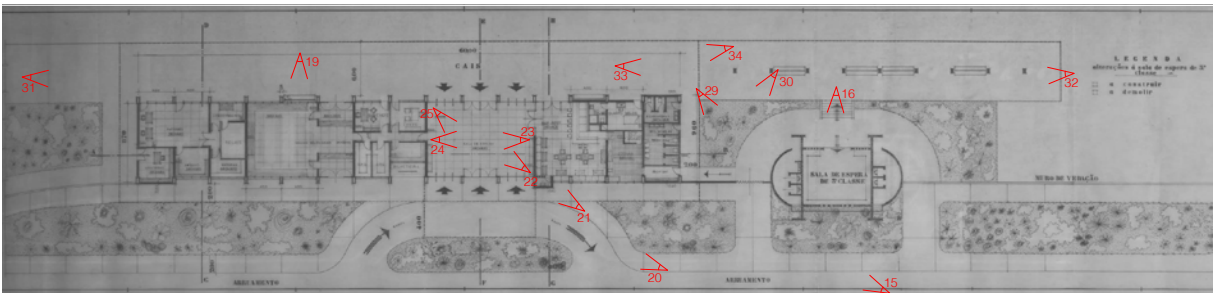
Pontos de vista das figuras 4.15 a 4.28. (CC, 2021)
